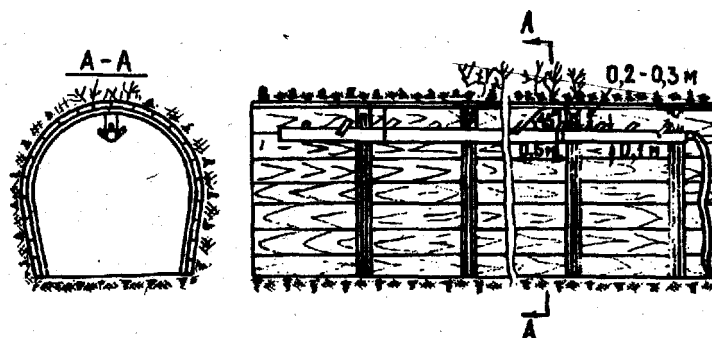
Схема размещения взвихрывающего трубопровода для ликвидации слоевых скоплений метана
